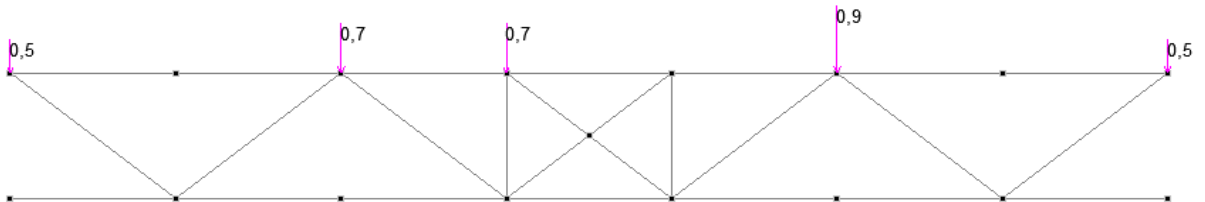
Нагрузки от конструкции кровли (постоянные),  $L_3$ , т
